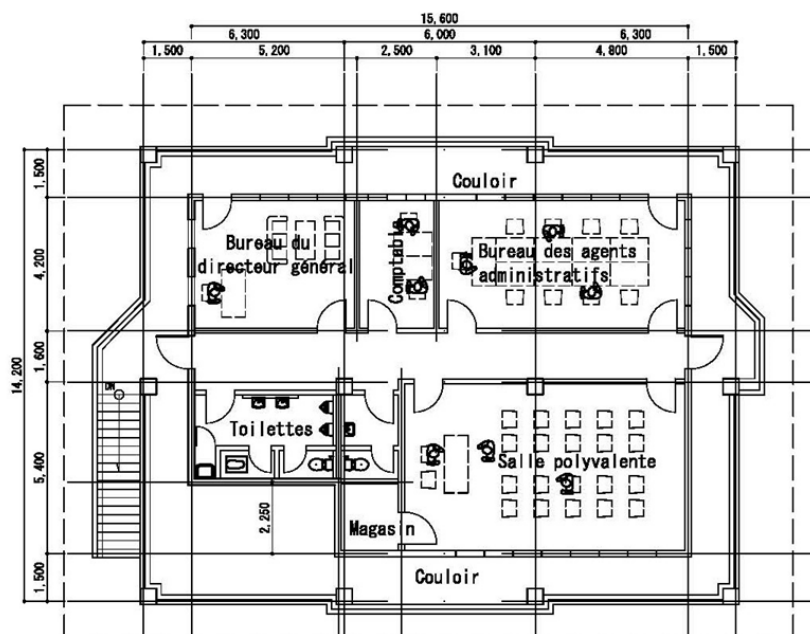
Plan du 1^{er} étage du bâtiment de stockage des produits halieutiques
